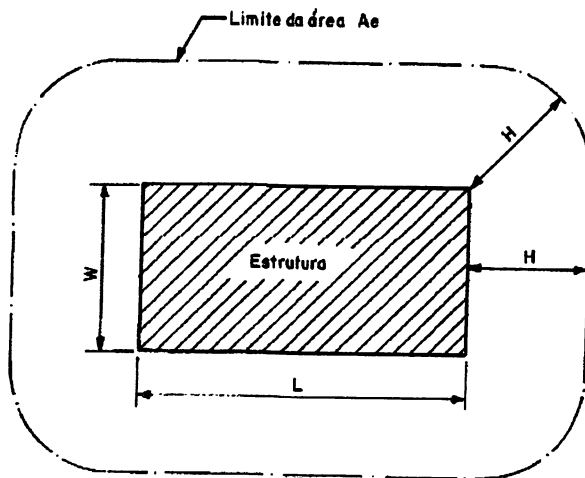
Delimitação da área de exposição equivalente (A_e) - Estrutura vista de planta
